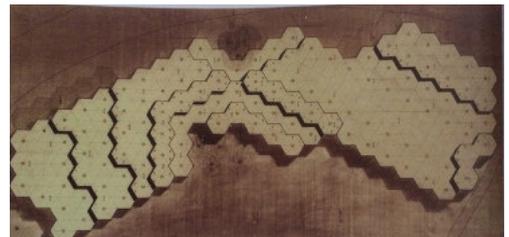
Plano de la estructura del pabellón español de Bruselas 1958.
